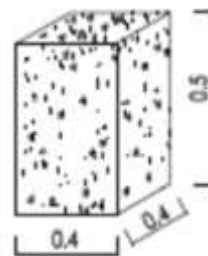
Fundações dos postes da Vedação Perimetral
